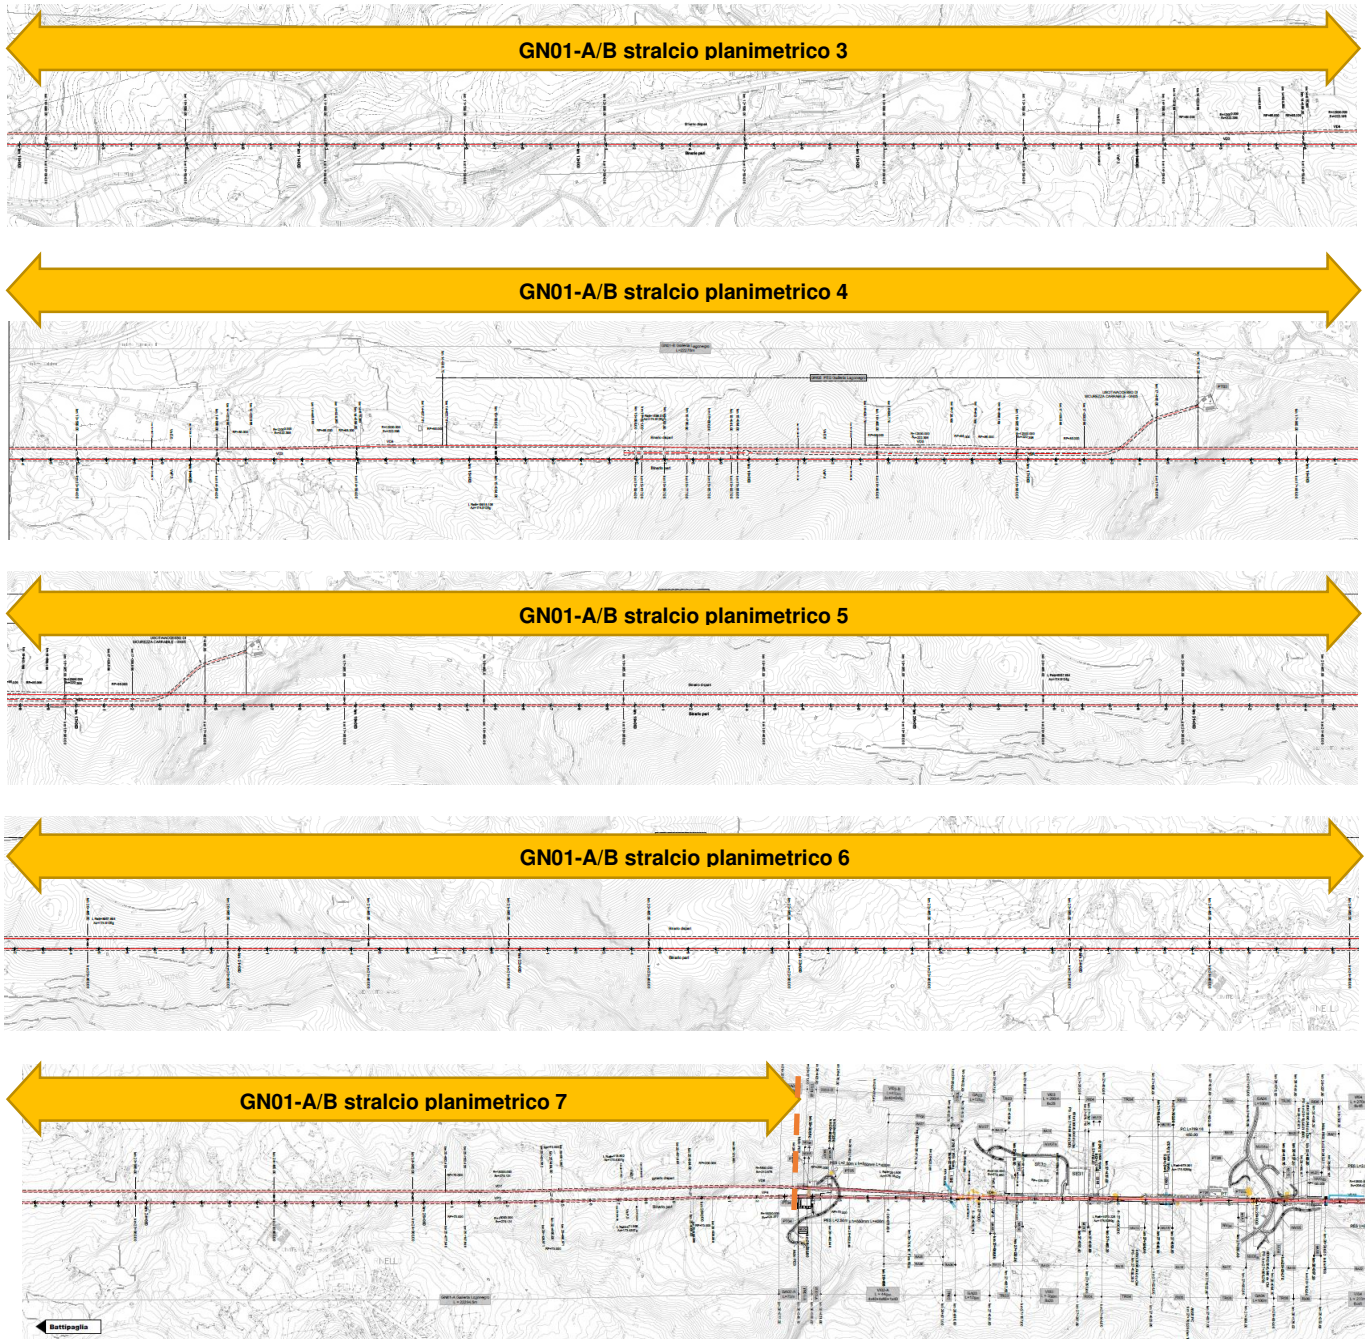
Planimetrie di progetto gallerie GN01-A/B da km 3+939 al km 26+349
